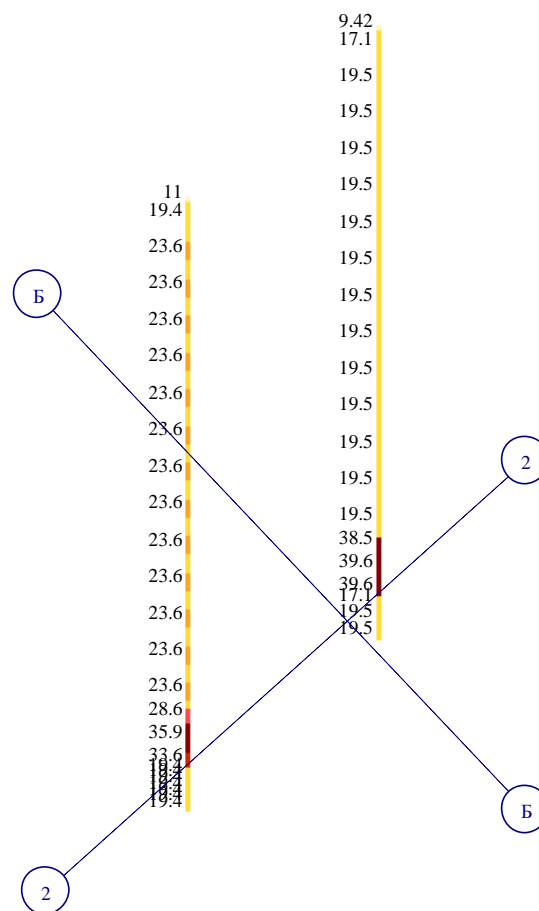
Площадь армирования колонн осях А/2 и Б/2
